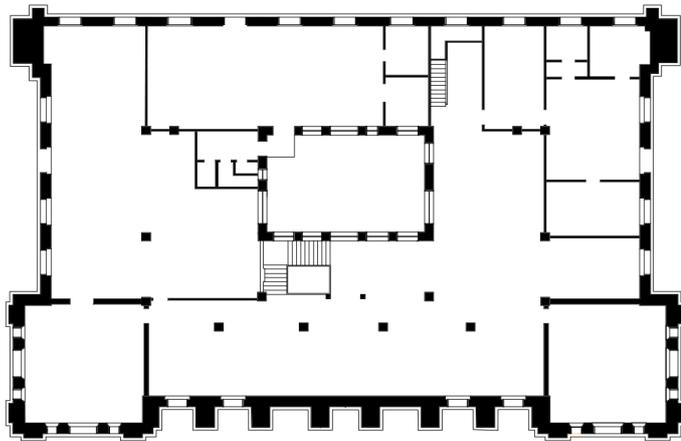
Redesenho planta do porão, Secretaria de Obras Públicas, 1944 .
